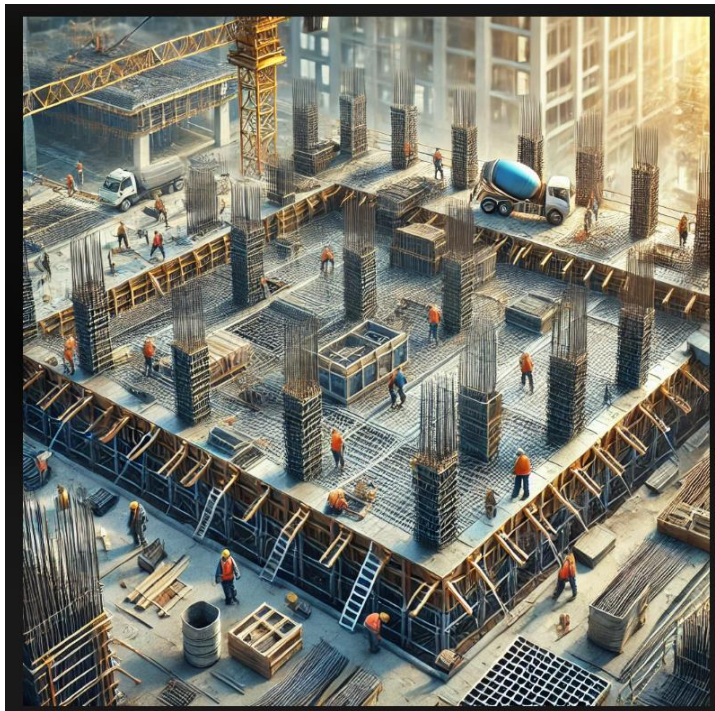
Зведення будівлі з монолітного залізобетону
